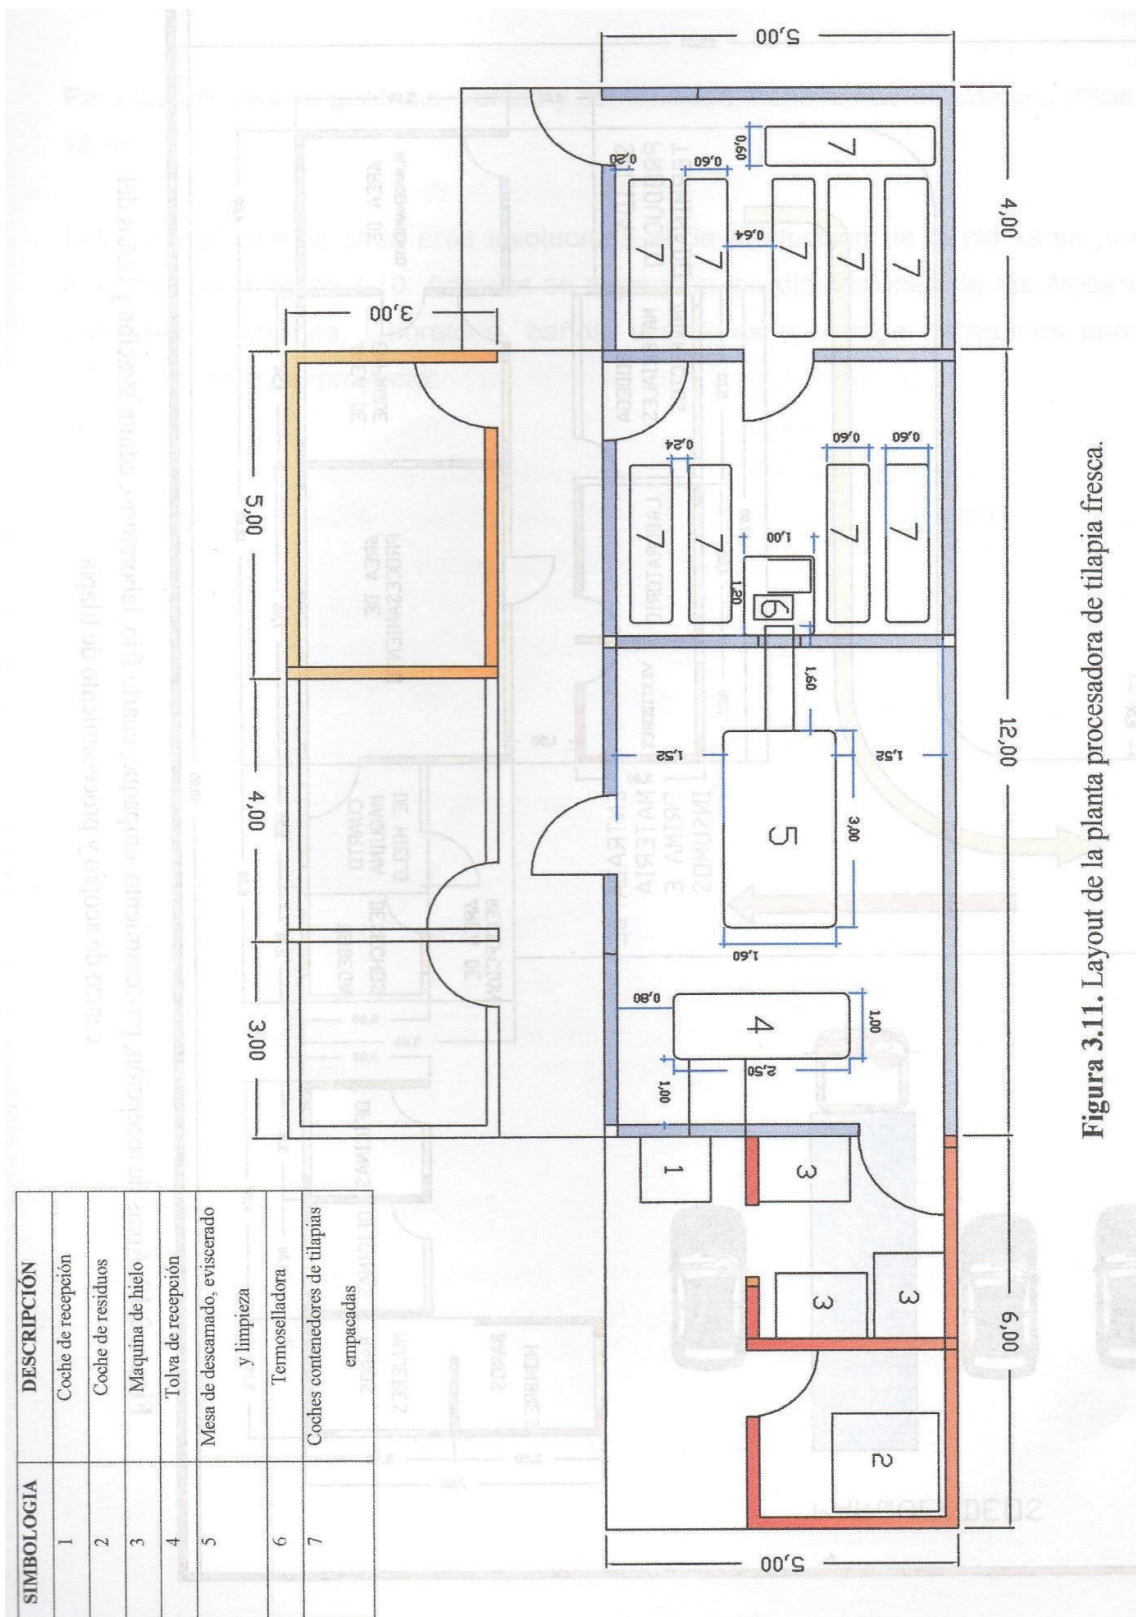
Layout de la planta procesadora de tilapia fresca.
